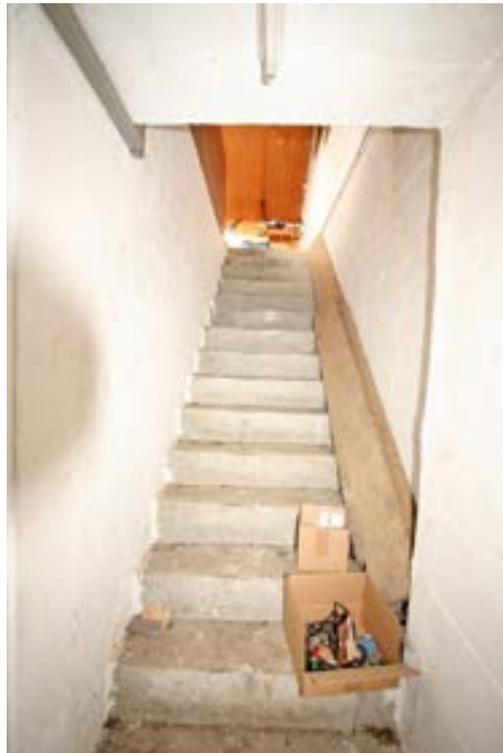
Treppe zum Dachgeschoss der Werkstatt
